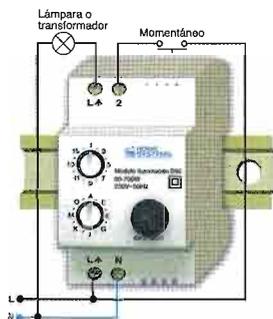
Montaje y conexionado de un módulo sobre carril DIN.
